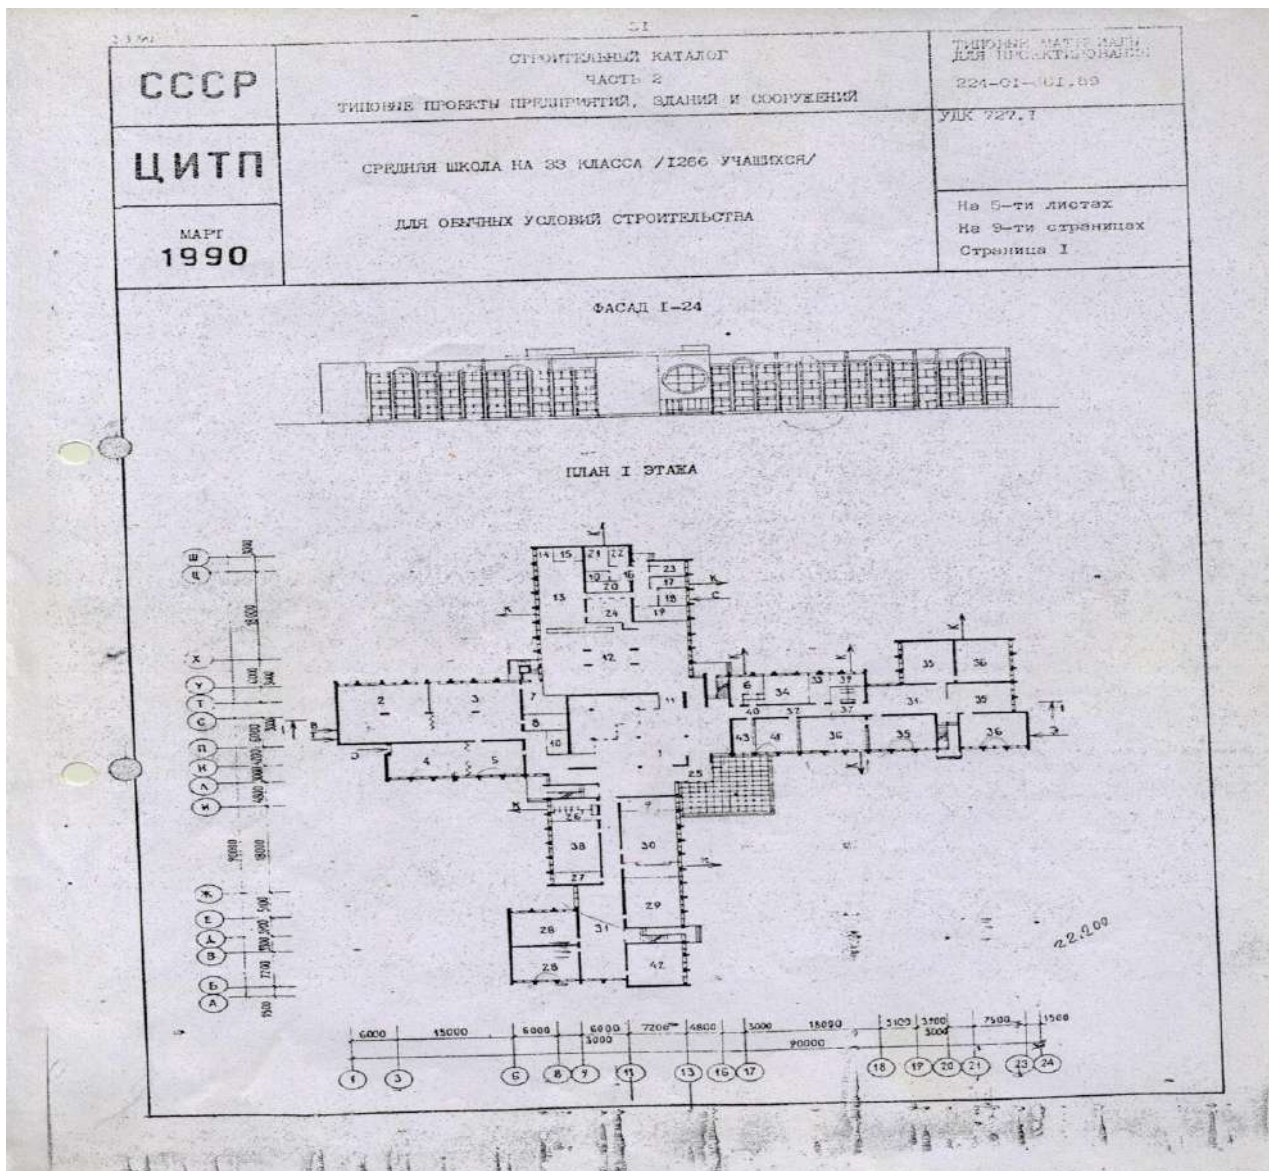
Фасад та план першого поверху проекту школи.
